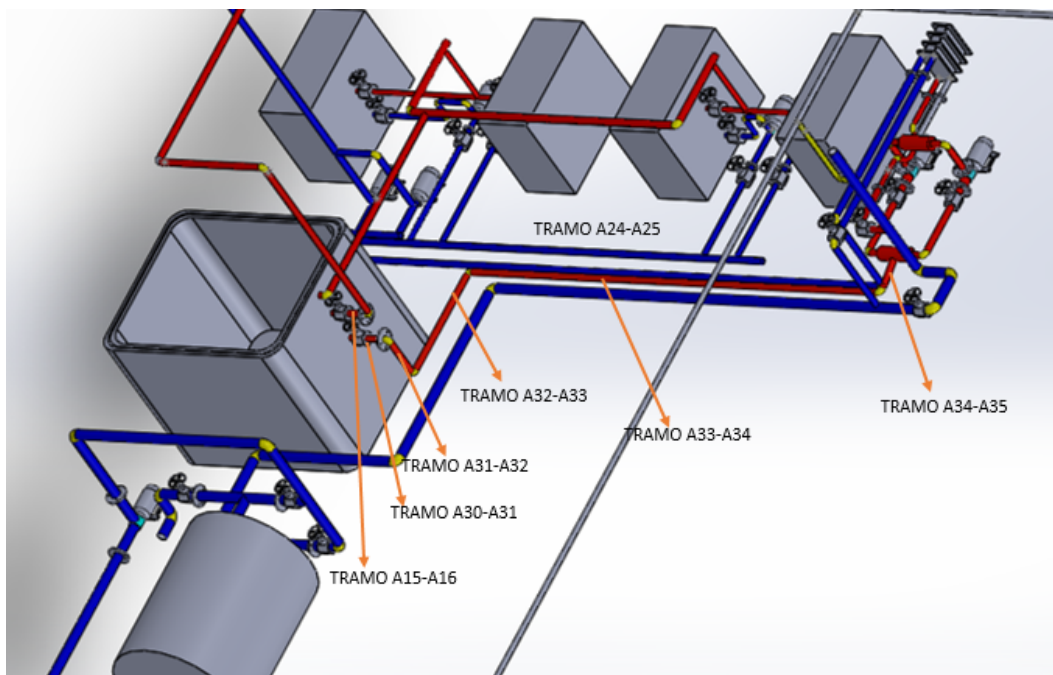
Tramo de tubería caliente planta baja. Autor
